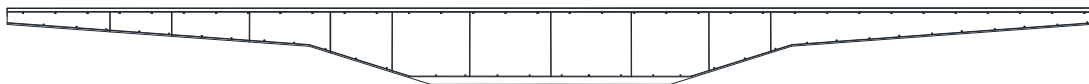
Железобетонная конструкция сложного профиля (тип II)
